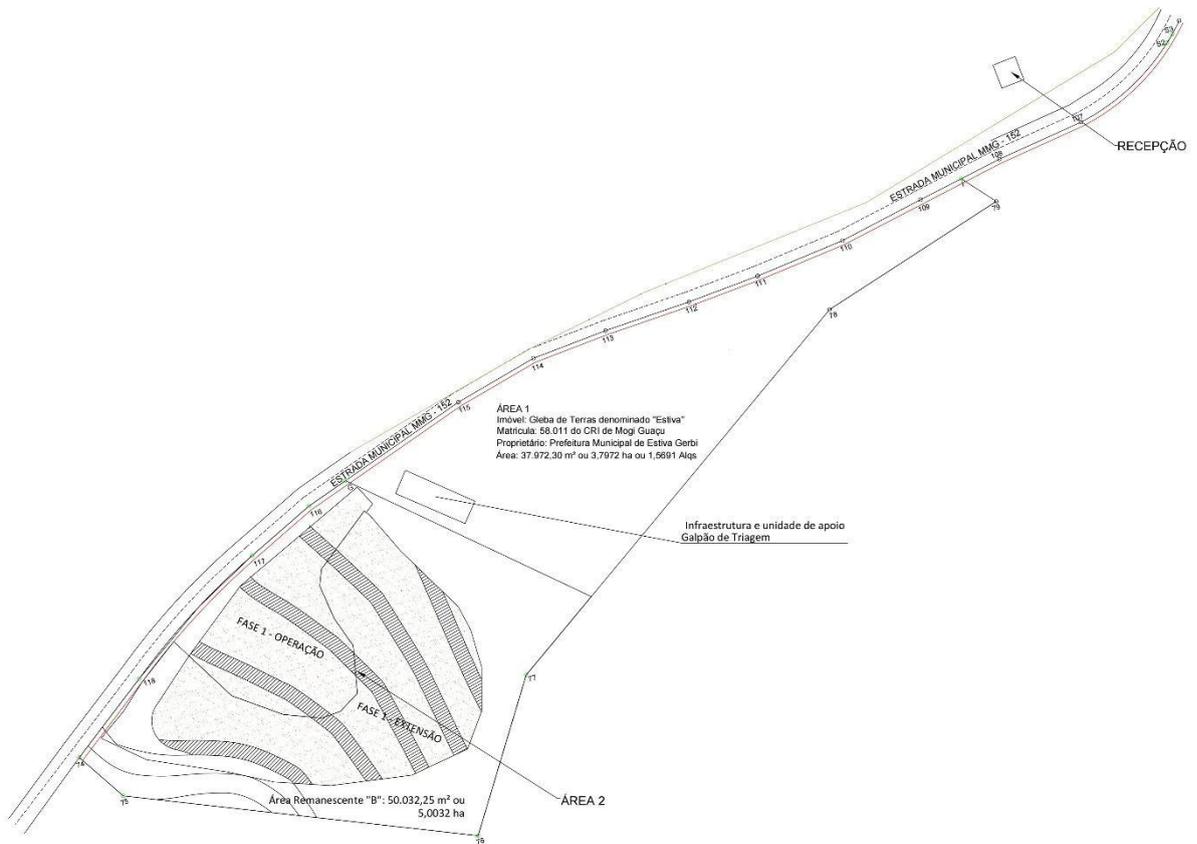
Layout projetado para extensão das áreas do aterro da Fase 1, Área 2.
